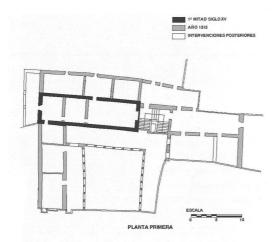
Planta alta. Etapas constructivas (López Bernal 2012)
